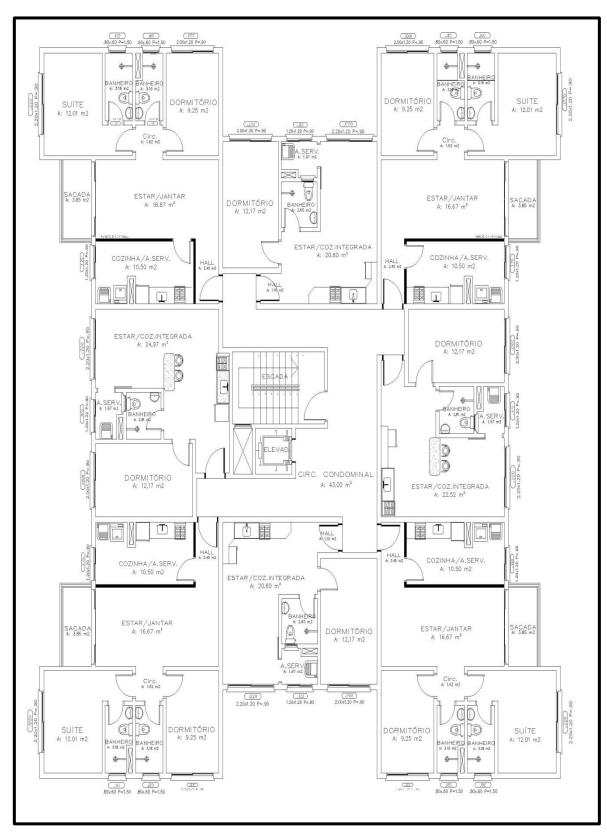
Planta baixa do pavimento tipo. (Fonte: Construtora¹, 2012).
